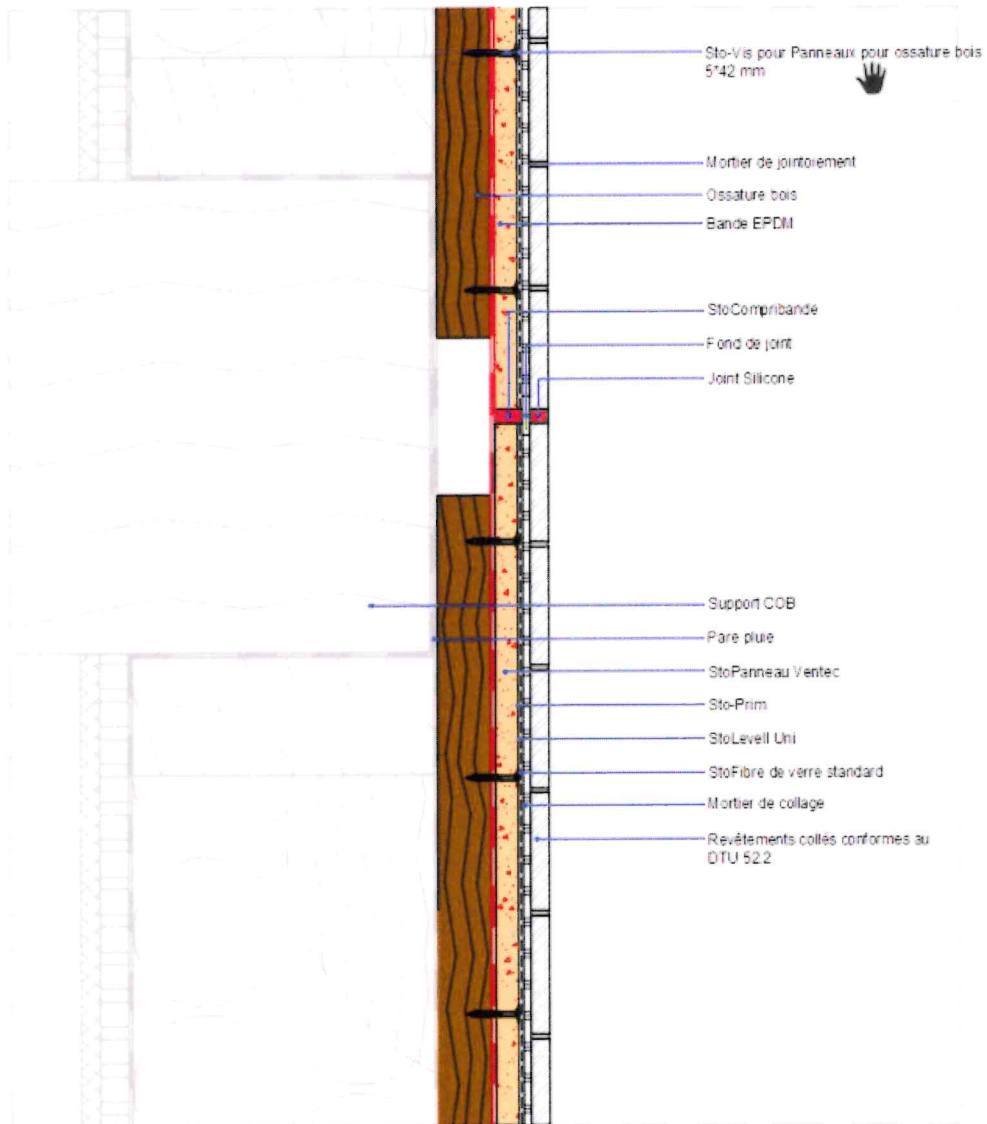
Détail de la jonction de système StoVentec SCM / Enduits (joint ouvert)
